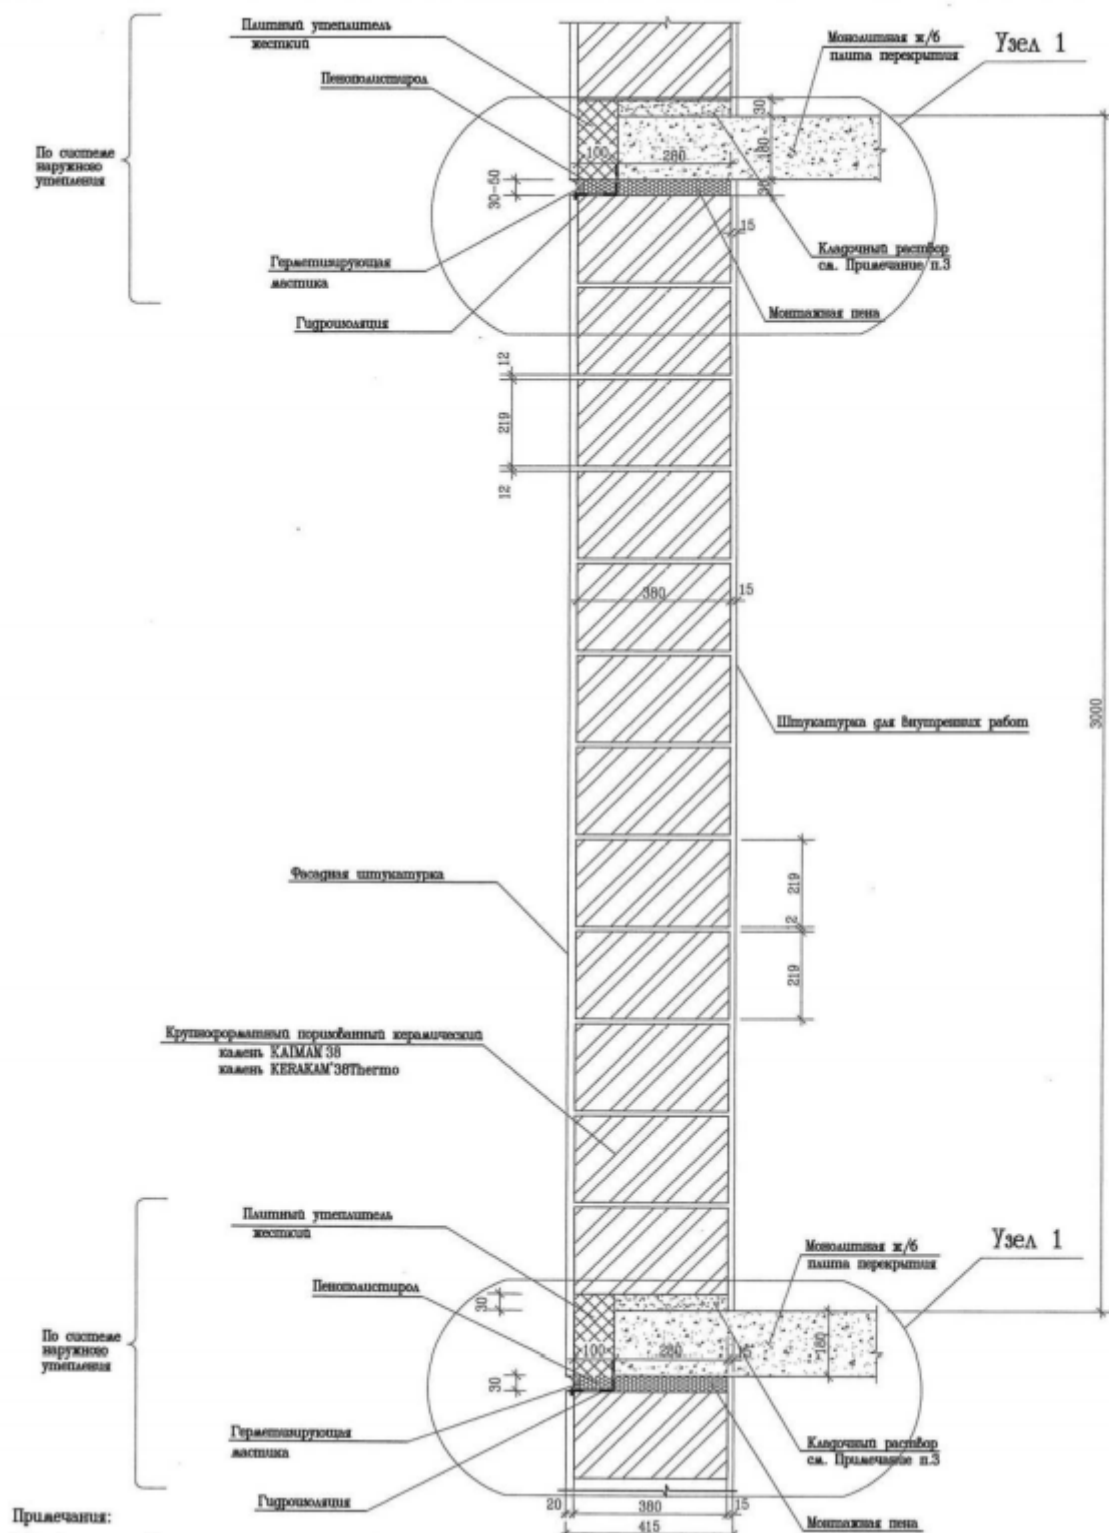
Разрез стены с плоской плитой перекрытия без проемов.
